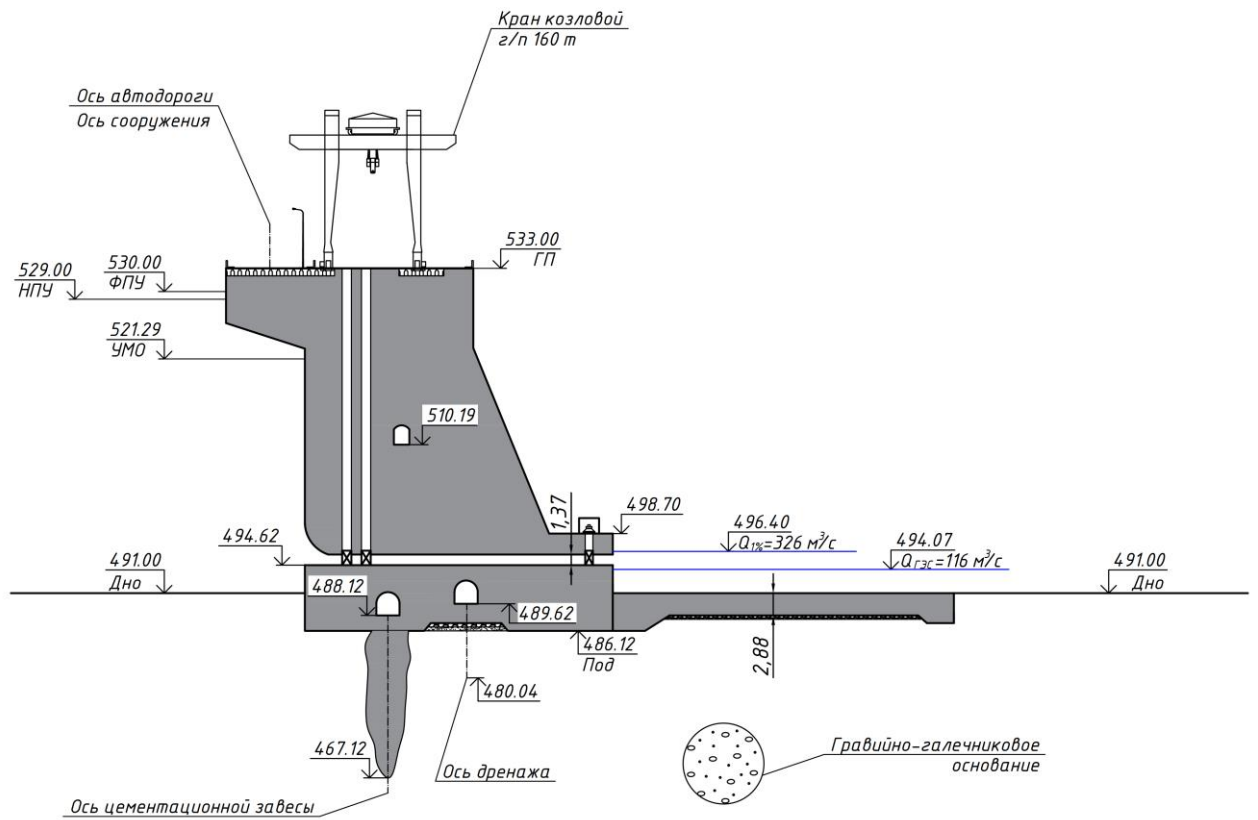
Поперечный разрез бетонной плотины по оси глубинного водосброса
